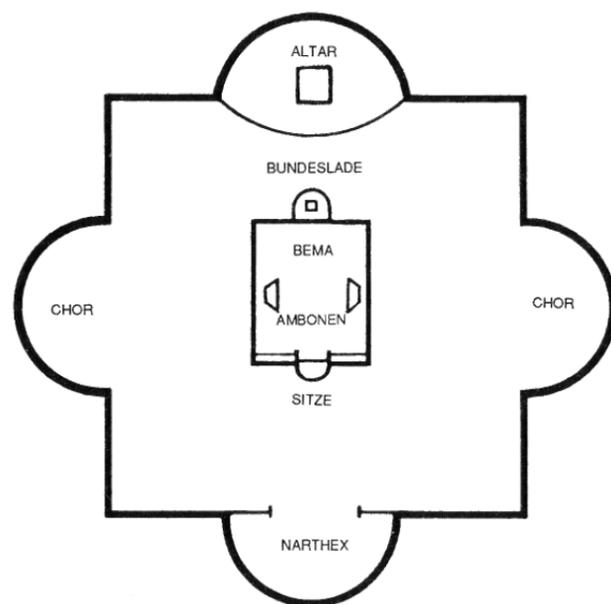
Grundriss, frühe byzantinische Kirche
